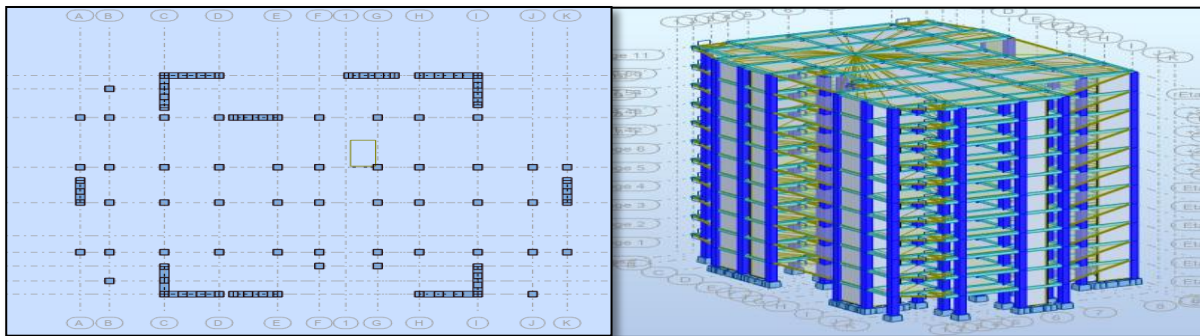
vue en plan et en élévation de la Deuxième variante (disposition finale)
